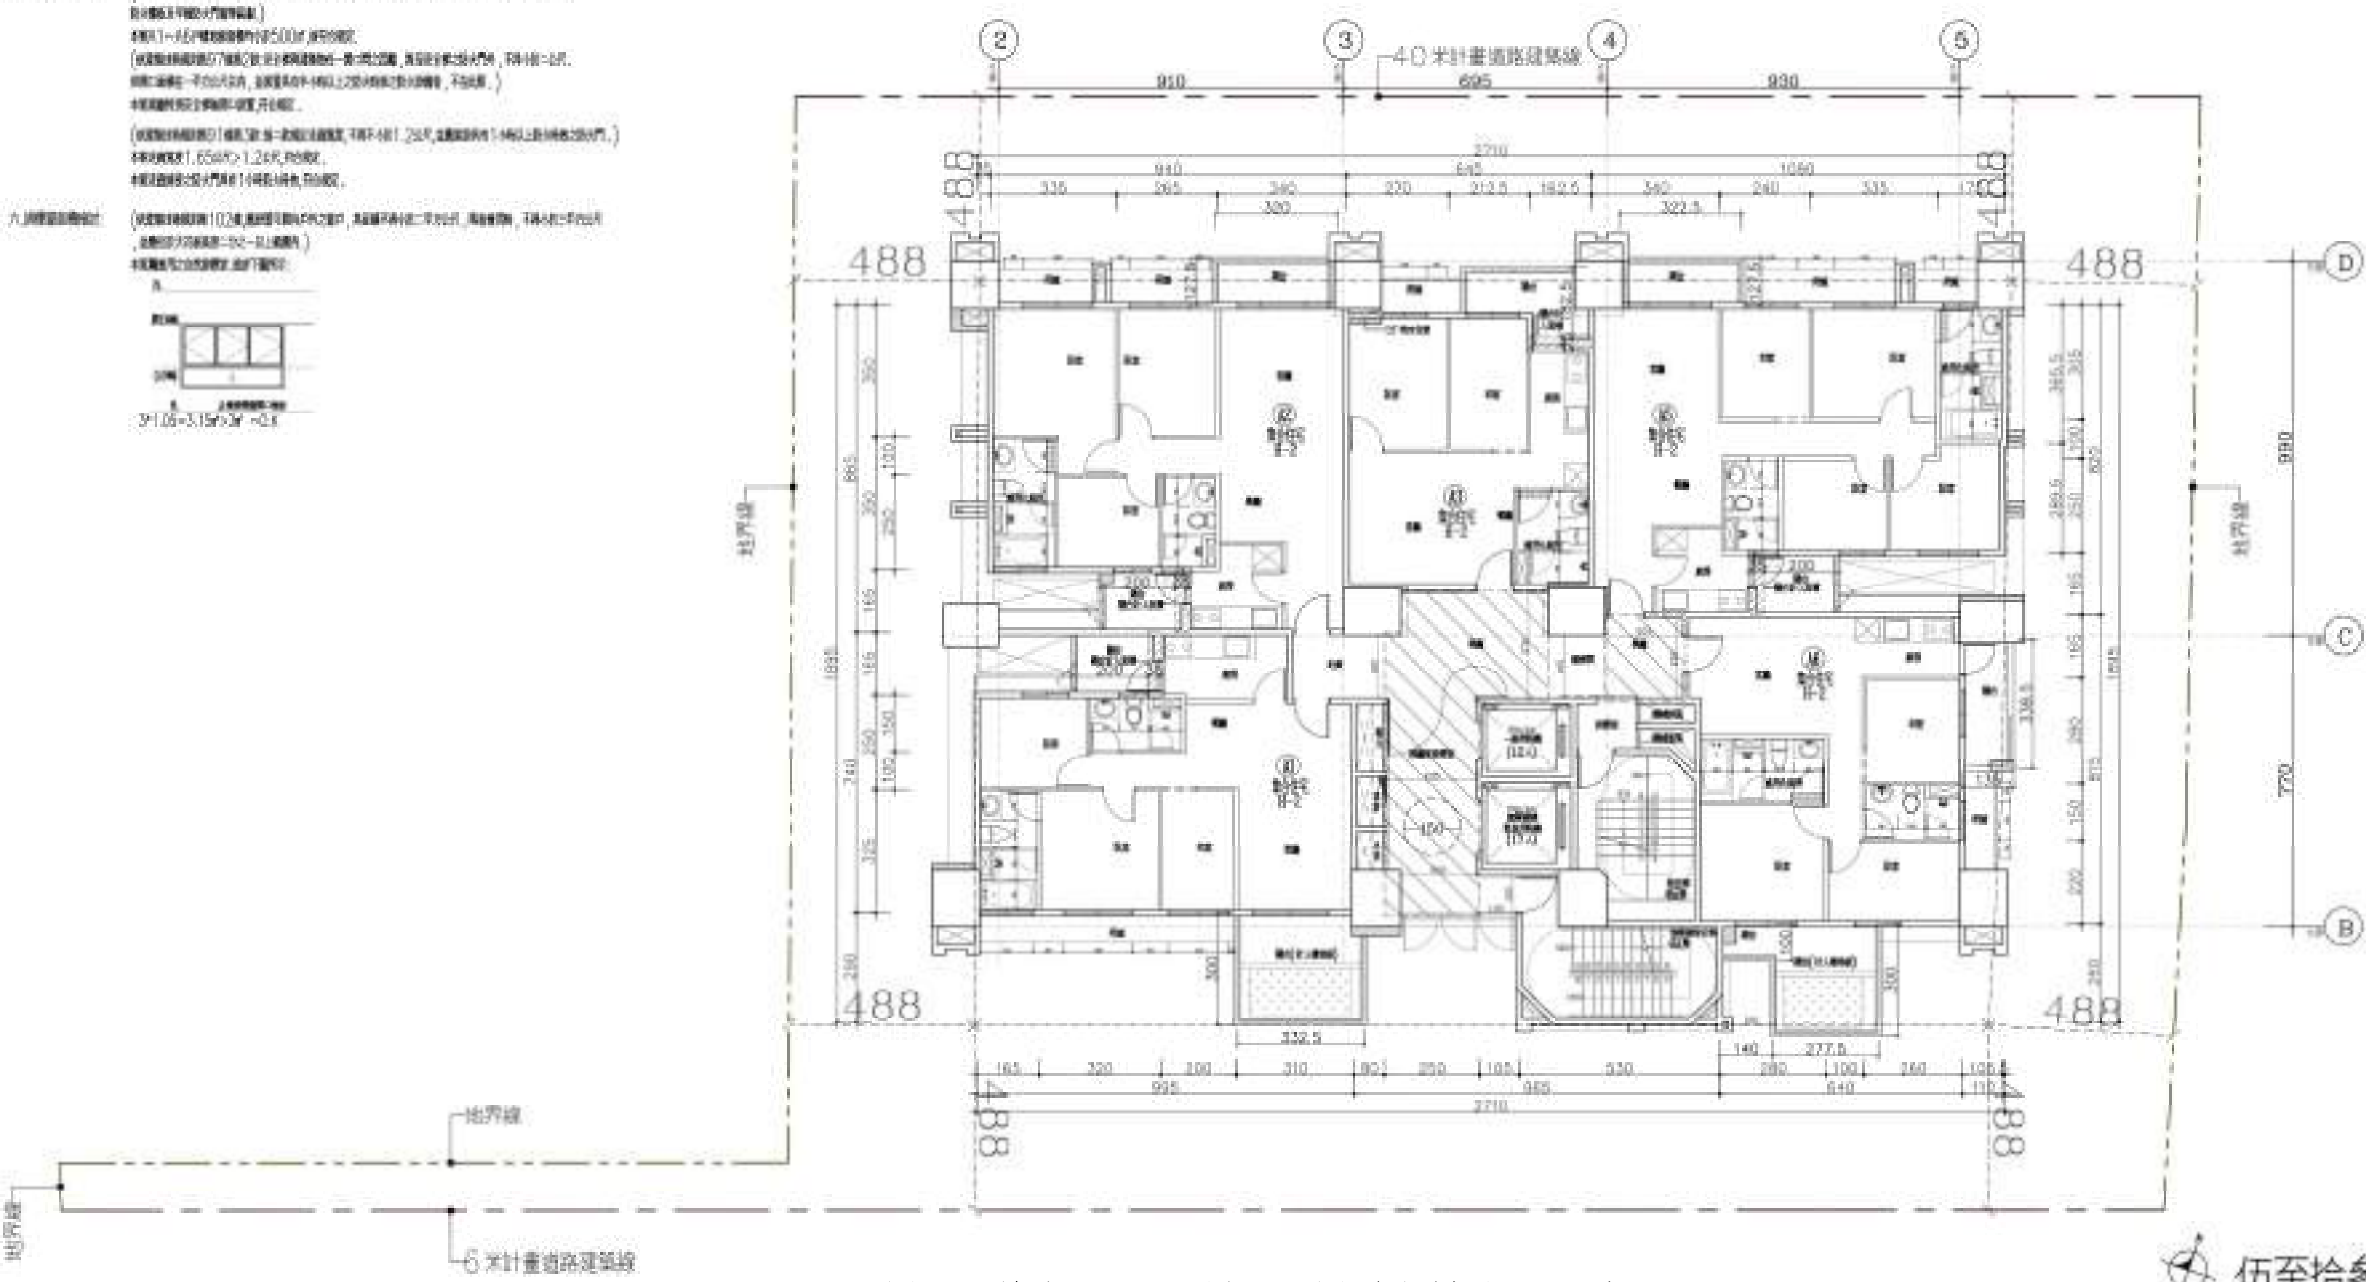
地上 5 至 13 層平面圖 (比例尺 1/200)
